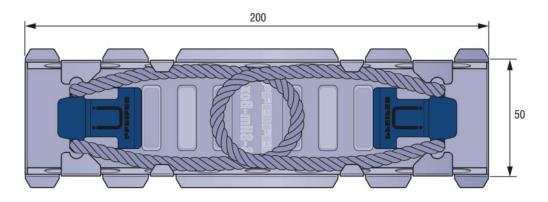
Draufsicht auf die geöffnete Box und die eingeklappten Seilschlaufen
